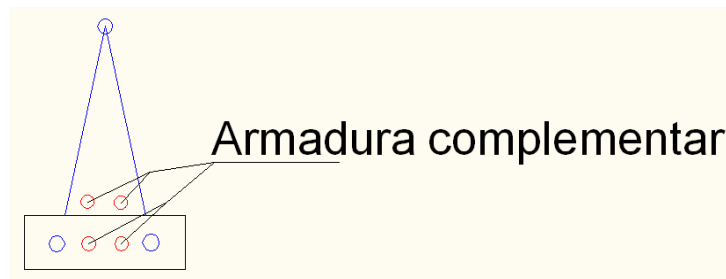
Armadura complementar em vigotas treliçadas.
